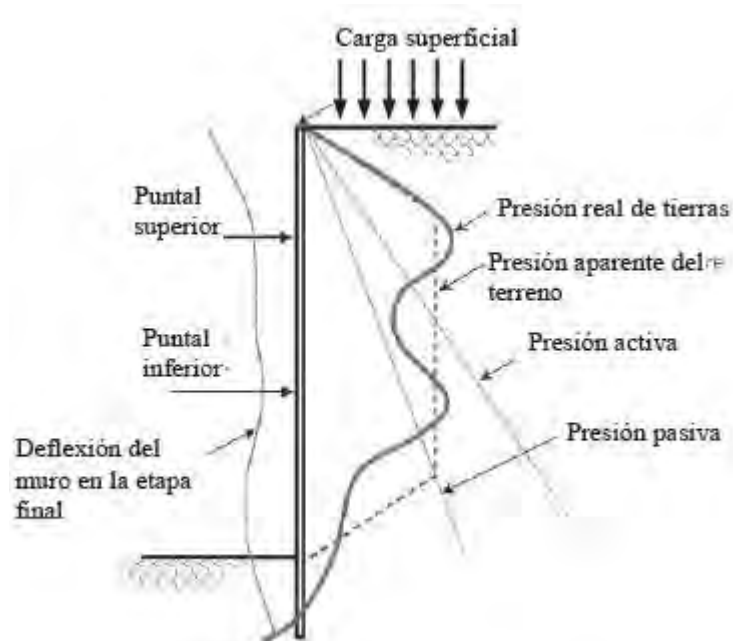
Cargas actuantes en un muro apuntalado. (Gerdau, 2017)
